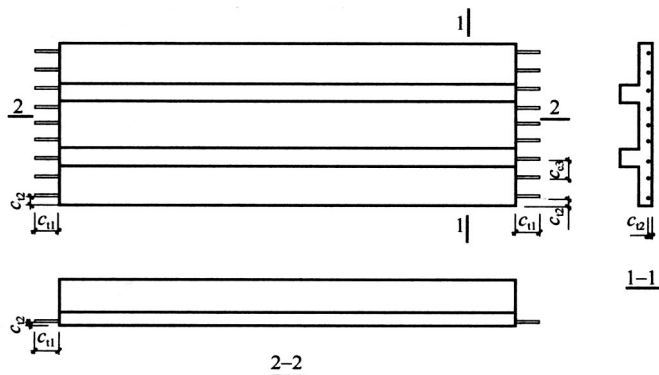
预制带肋底板预留外伸钢筋尺寸允许偏差示意
